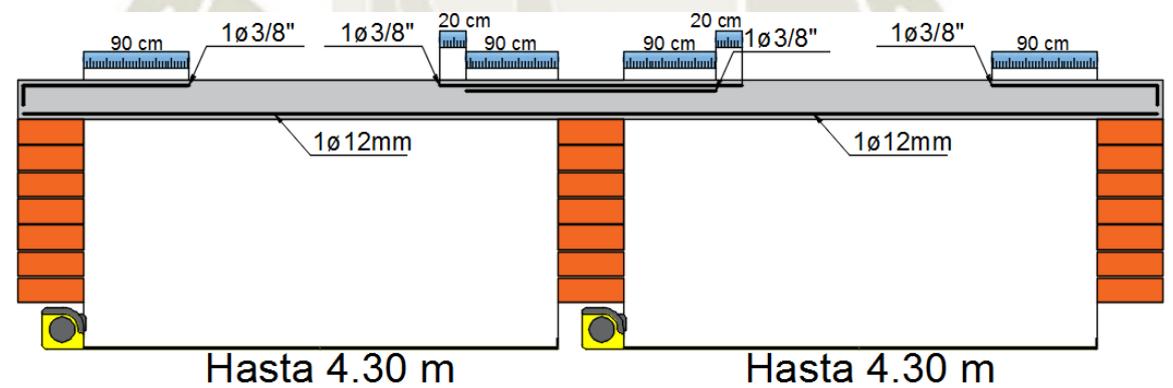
Refuerzo de vigueta hasta 4.30 m por tramo.
